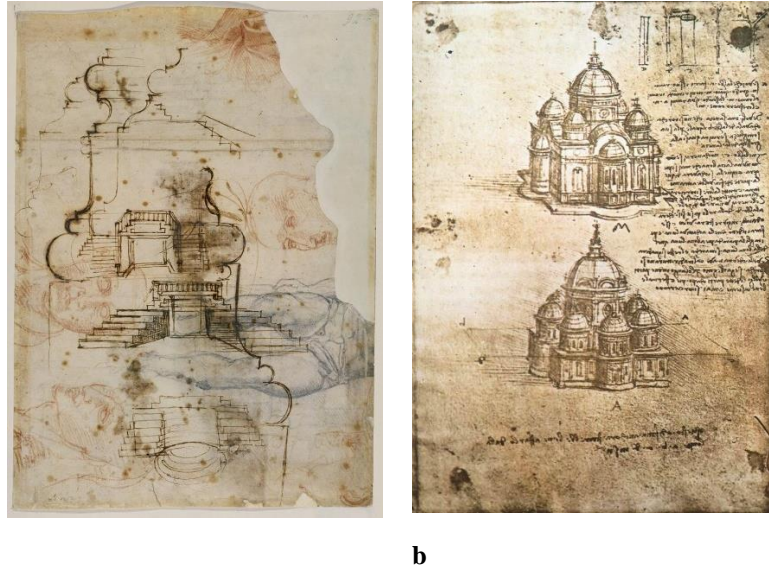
a. Michelangelo. Croquis para Biblioteca Laurentiana, Florença, Itália (1523-1559)²⁸ b. Leonardo da Vinci. Estudos para edifício de planta centralizada, (1480).²⁹
